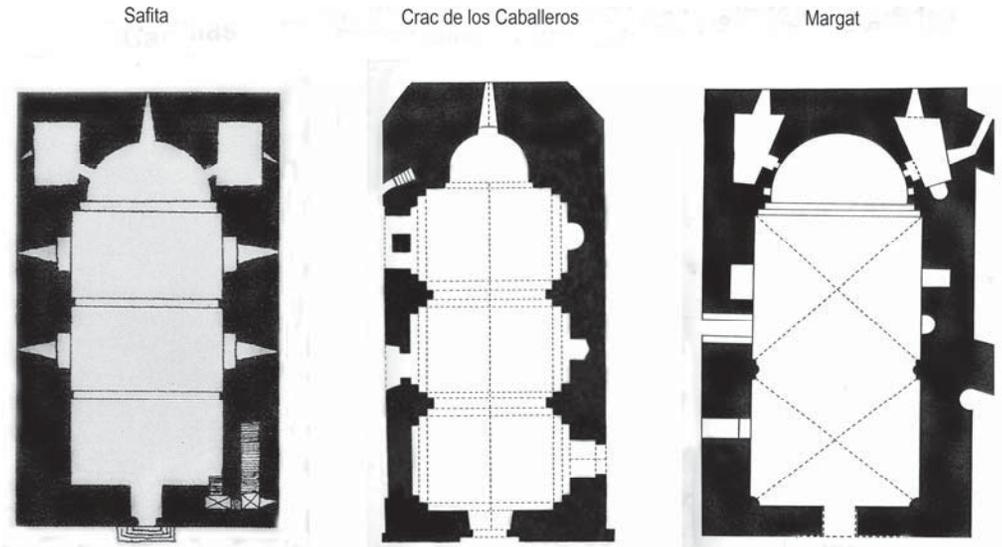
Plantas de castillos templarios y hospitalarios de Siria: planta de Safita, planta del Crac de los Caballeros y planta de Margat.
